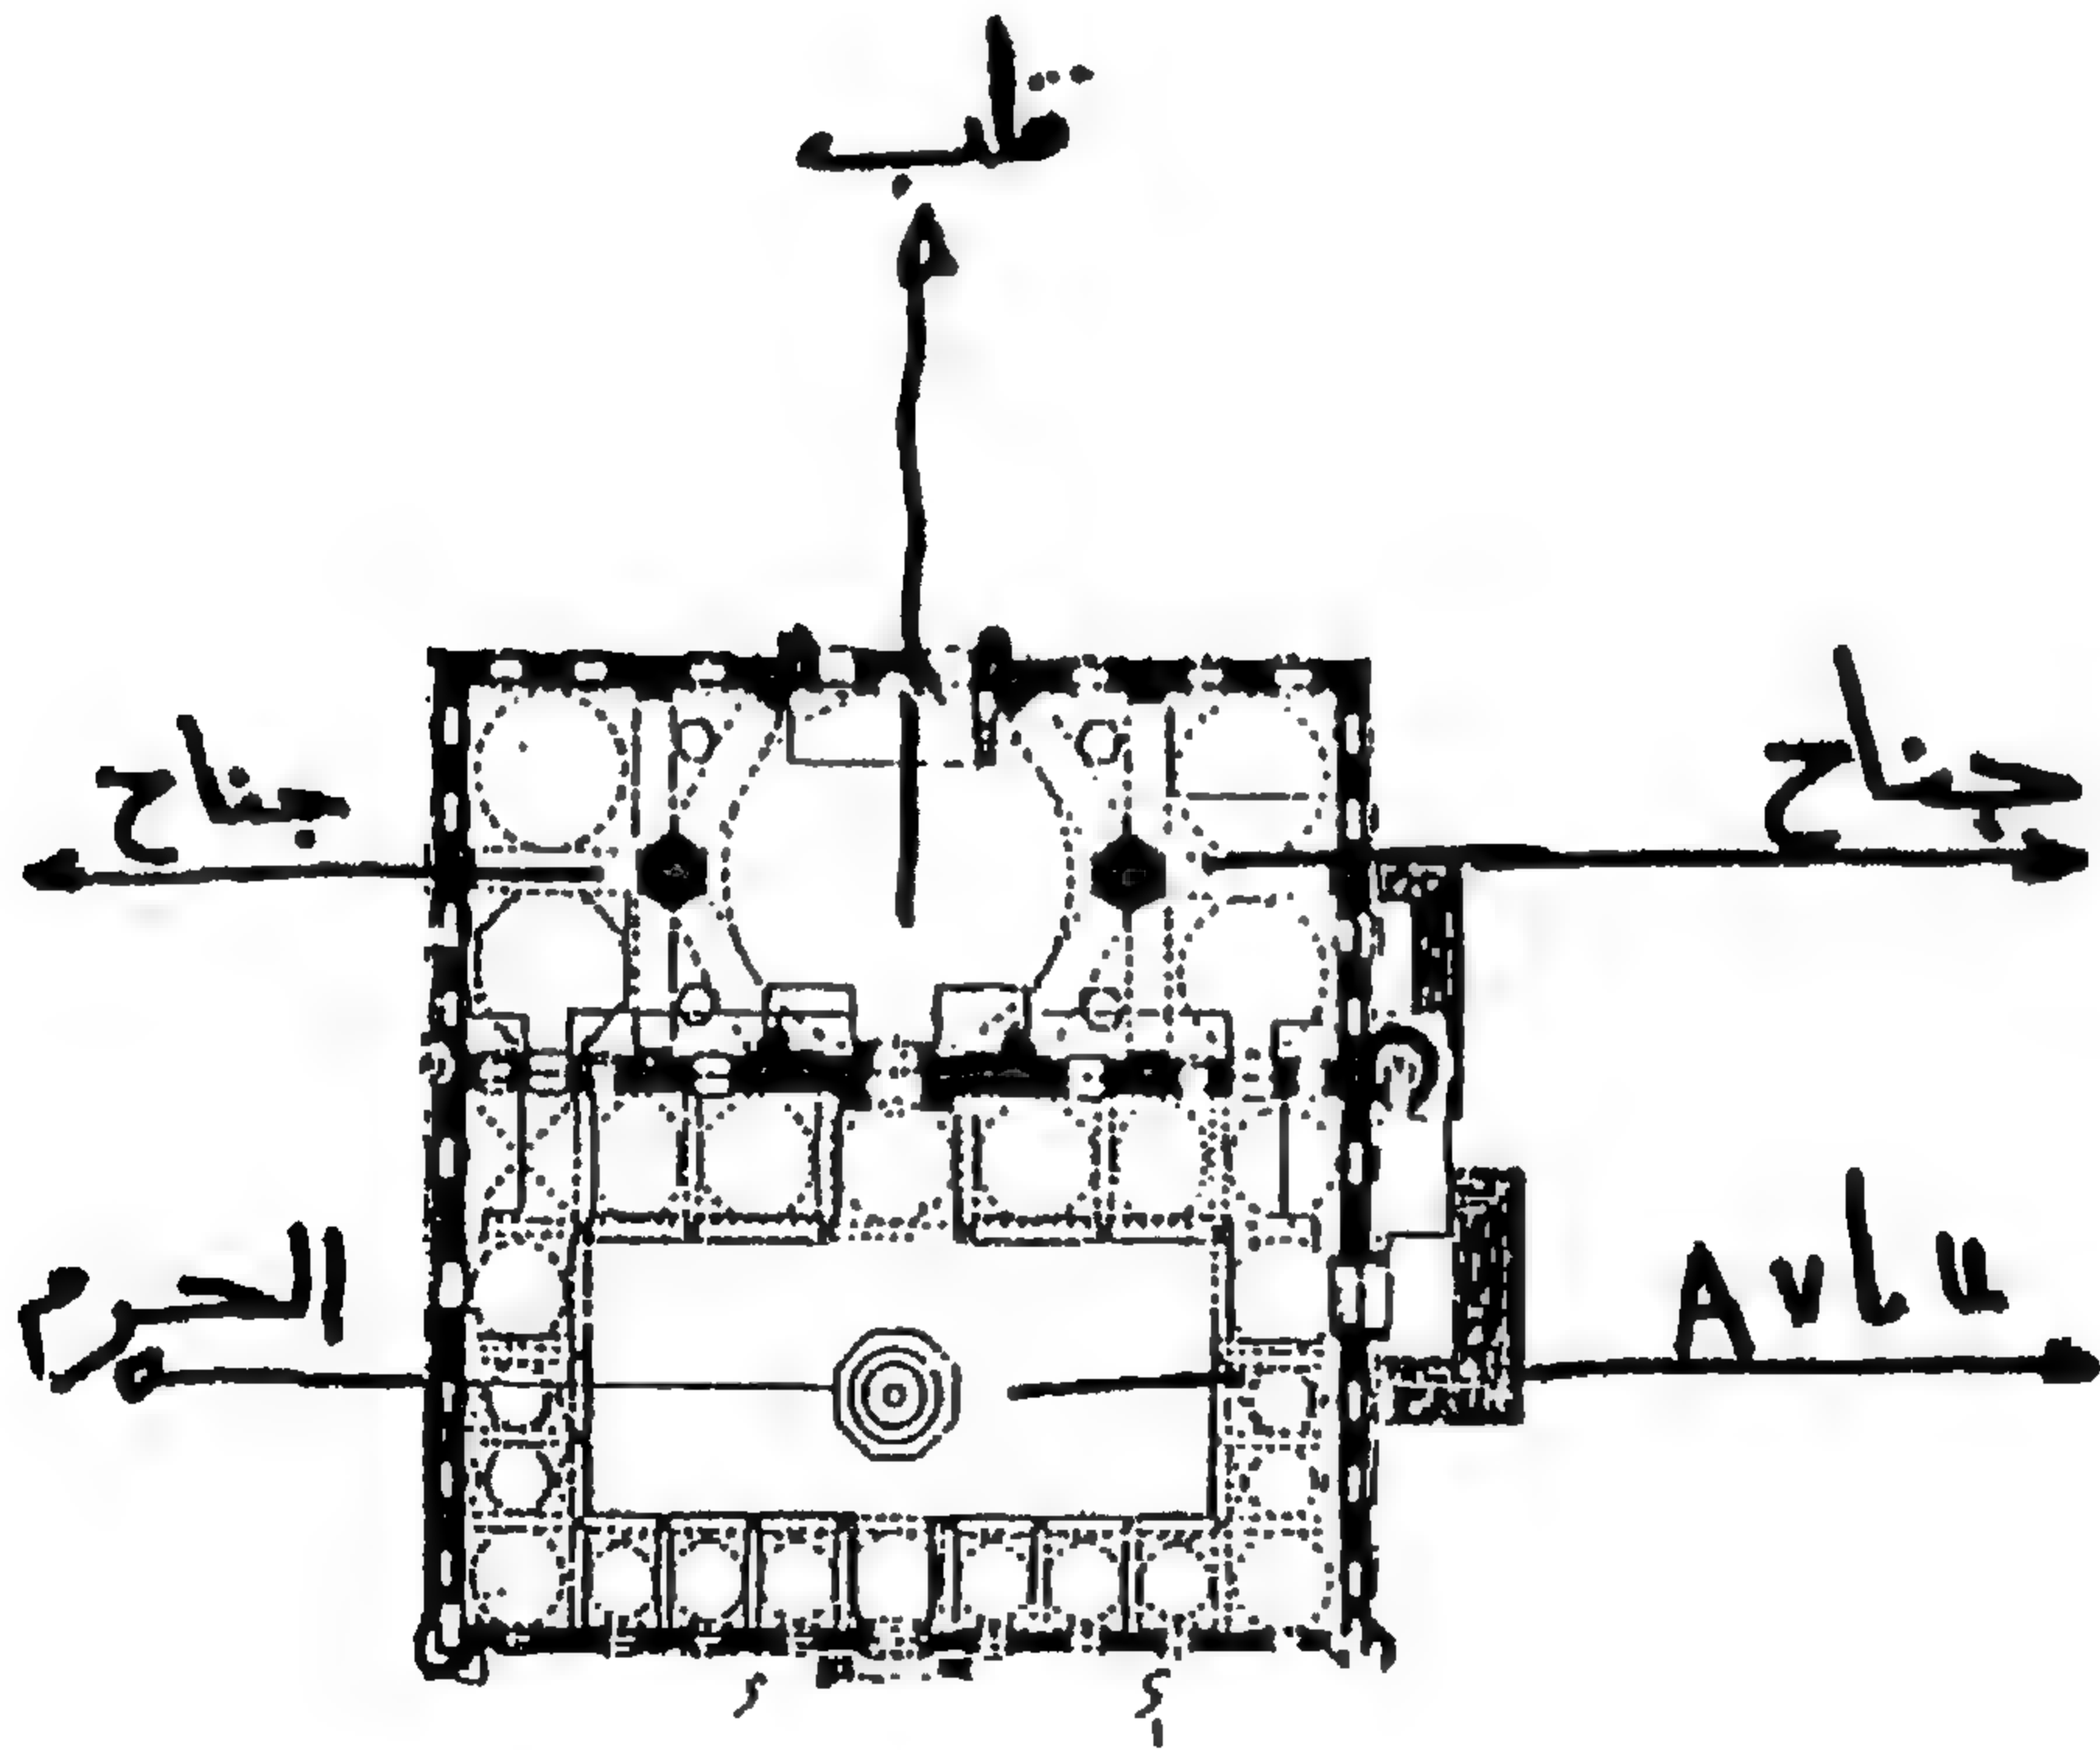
مسقط أفقي لجامع المؤيد شيخ لبسكال كوست ، قام برسمه هرتس باشا
